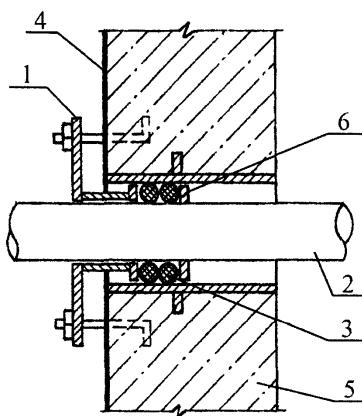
Схема устройства пропуска технологических трубопроводов через гидроизоляцию с прижимным сальником
